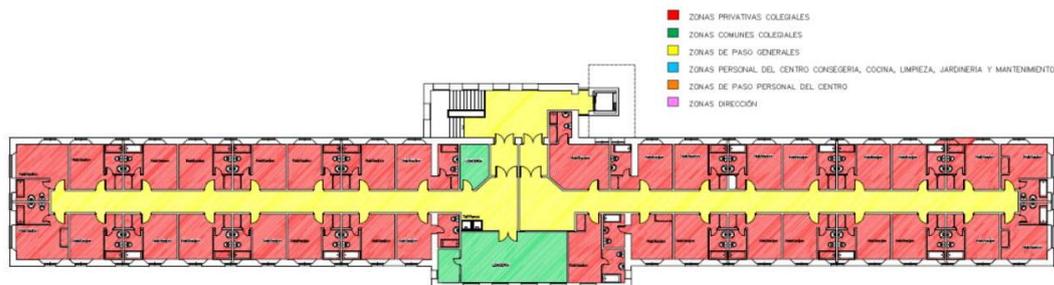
Plano de Usos Planta Tercera del colegio mayor Hernando Colón. Fuente: Archivo C.M.H.C.
